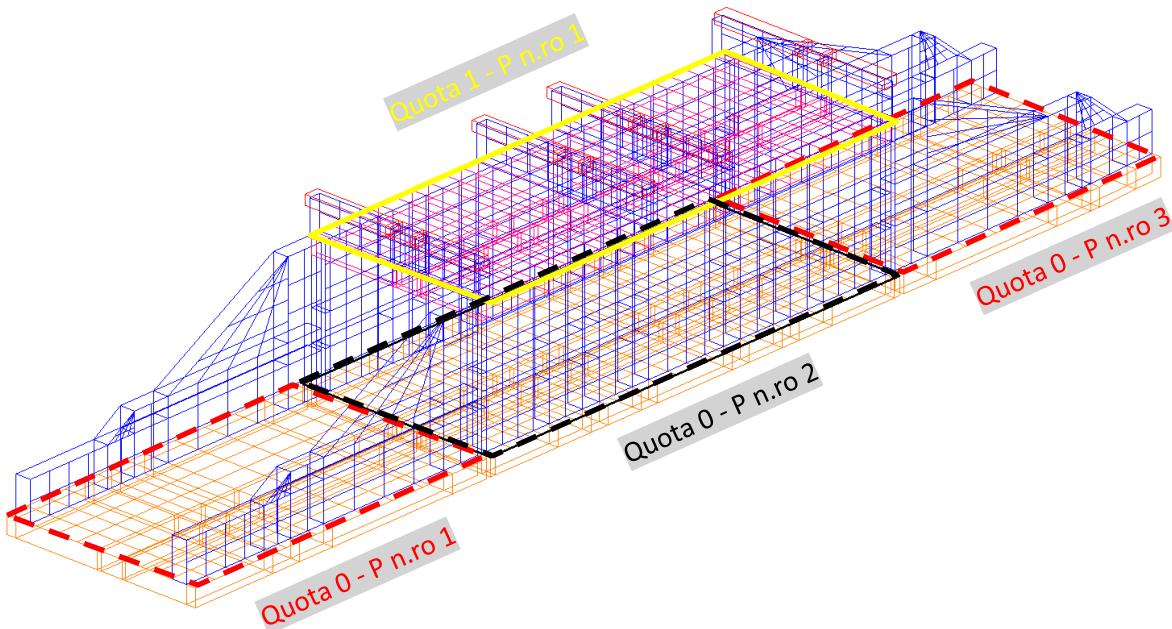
“Definizione dei perimetri delle piastre (di fondazione e di copertura)”
